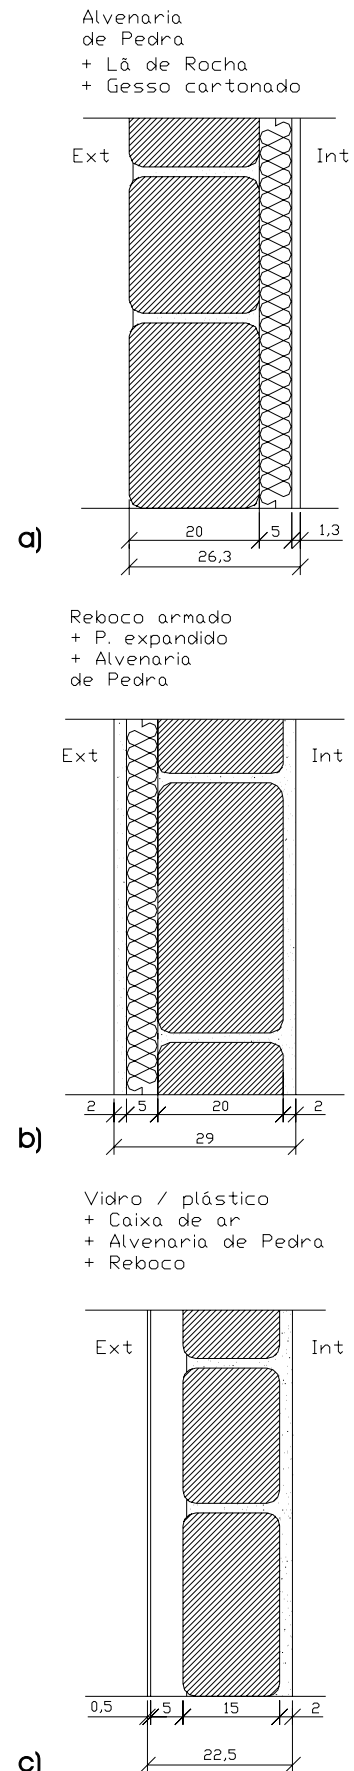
Soluções de reabilitação higrótérmica de paredes simples de pedra: a) isolamento interior; b) isolamento exterior; c) parede de Trombe
